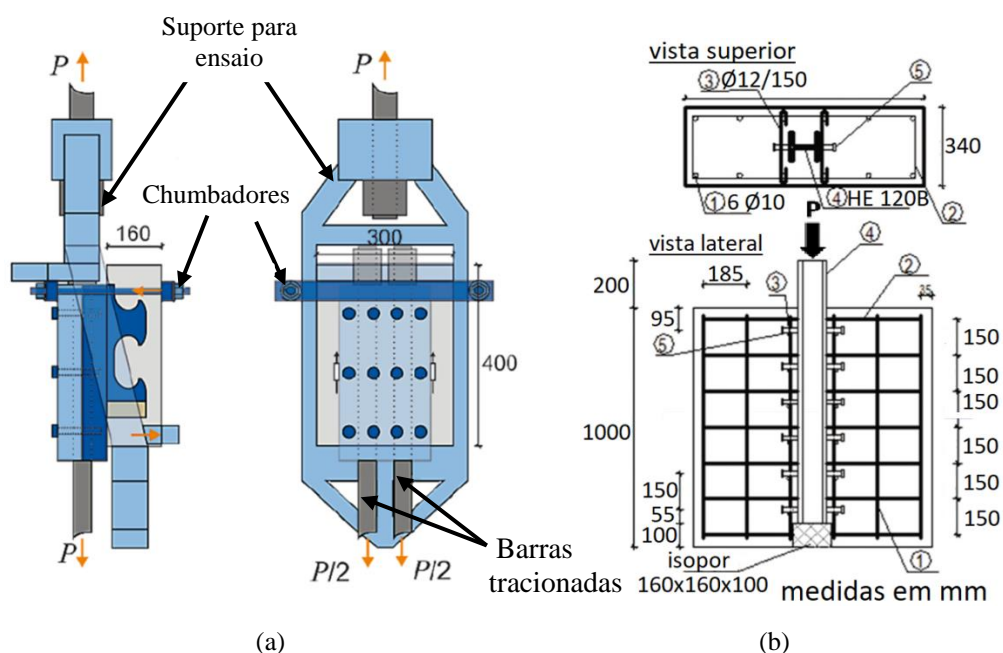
Ensaios de cisalhamento para a caracterização do comportamento de conectores: (a) adaptação para a análises de um *dowel* de concreto individual utilizando conectores *clothoidal shaped* (Classen e Joerg Gallwoszu, 2016); (b) adaptação para a análise do comportamento de conectores pinos com cabeça soldados em perfis I utilizados em conjunto para o reforço de pilares existentes de concreto armado (Degée *et al.*, 2017).
